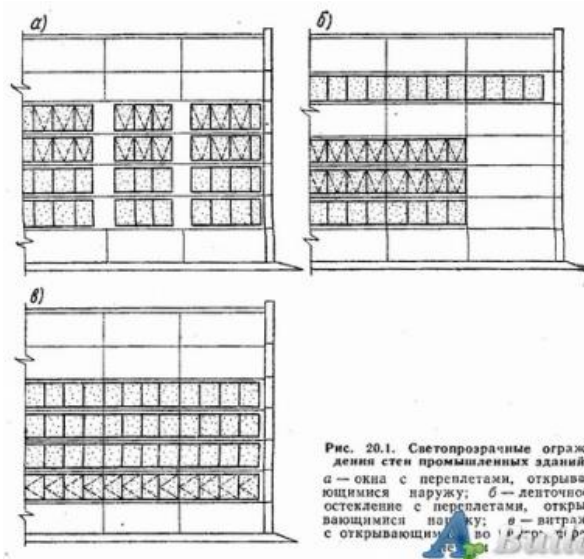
Светлопрозрачные ограждения стен промышленных зданий
